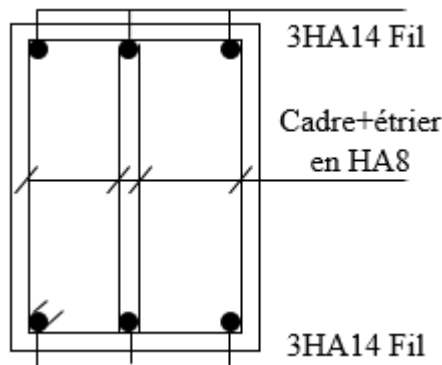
Ferraillage en travée d'une poutre palière.
